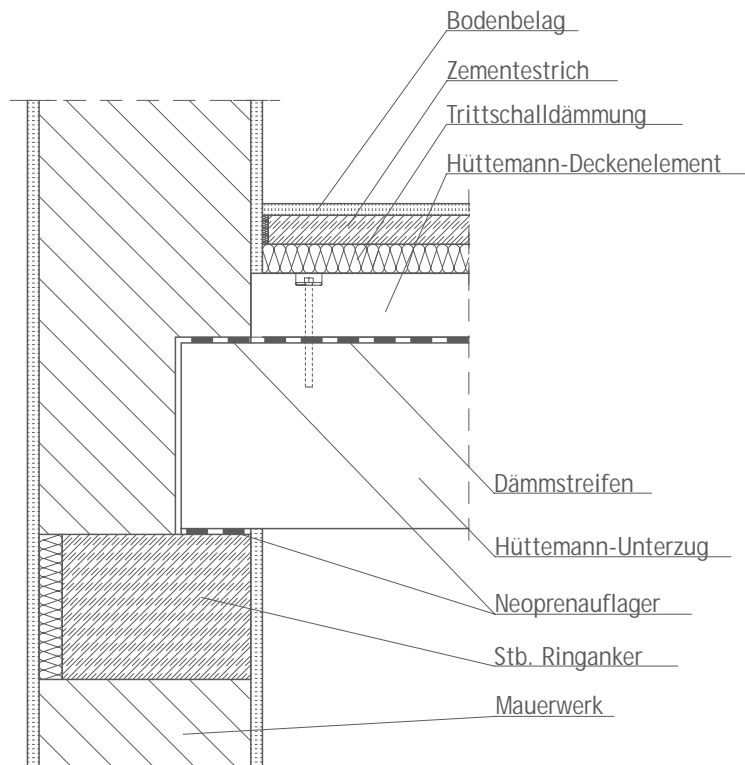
ANSCHLUSS DECKENPLATTE-MASSIVWAND
